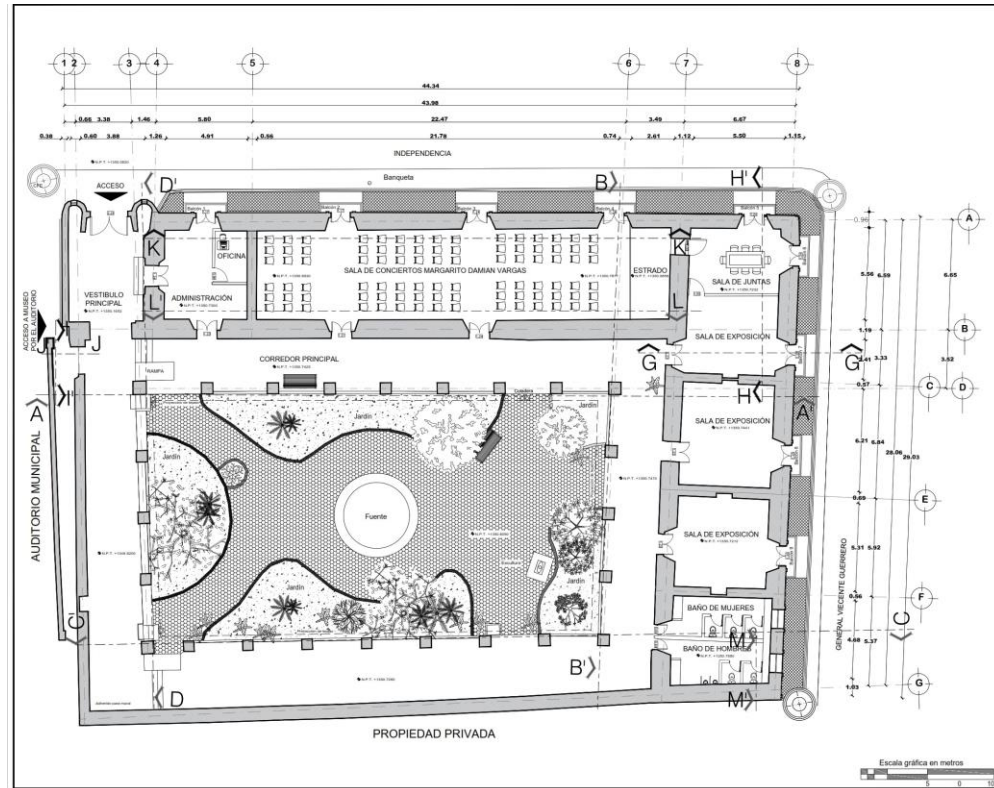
Planta arquitectónica del estado actual de la Casa Grande Vicente Guerrero. Fuente: Elaboración propia 2022.
